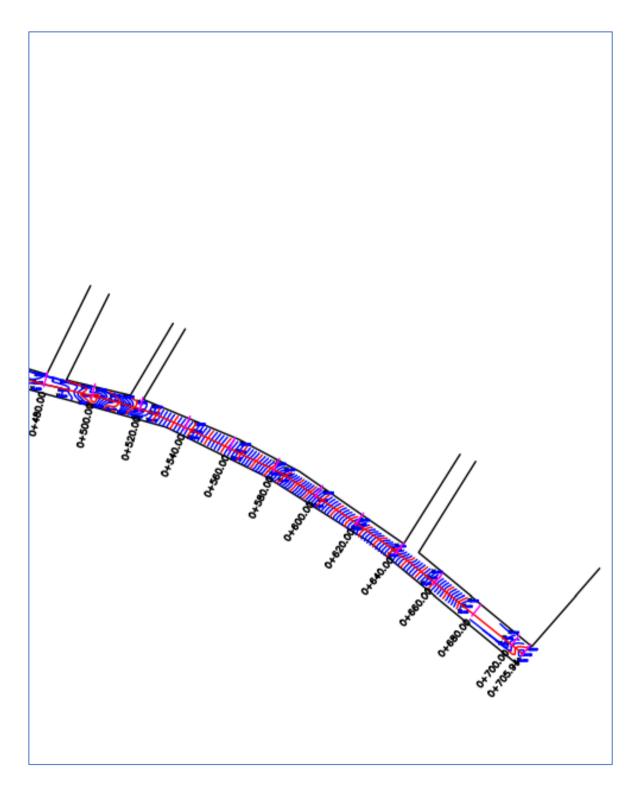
Vista 1 - Perfil longitudinal San Isidro
